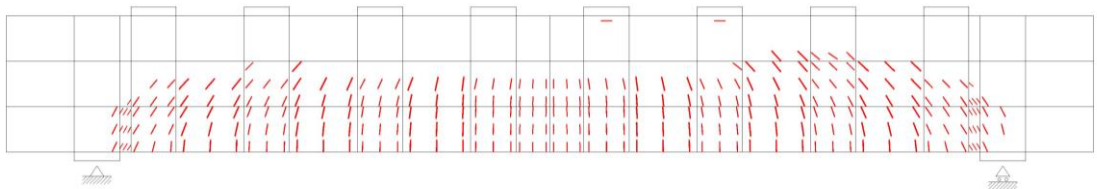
破壊時の変形及びひび割れ状態 (Case No. 10)
